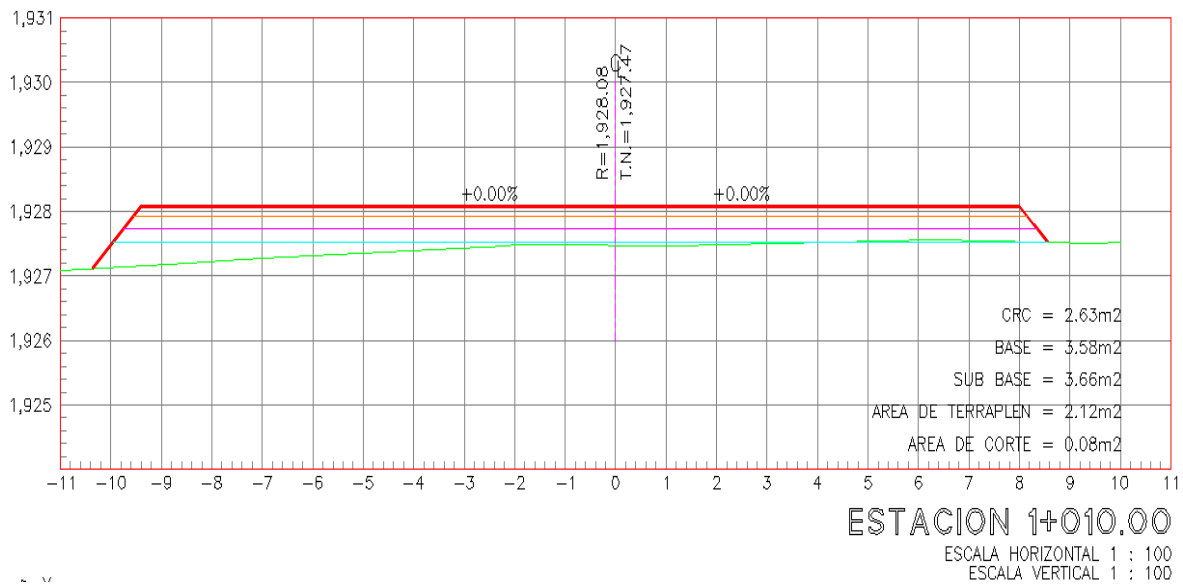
, Sección de pavimento, Fuente: Diseño e ingeniería, 2016.
